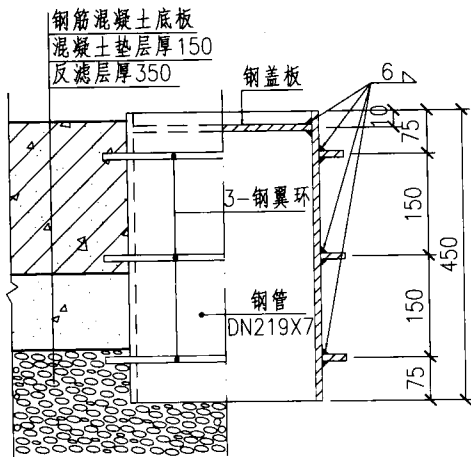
~4号钢筋混凝土沉井化粪池	图集号	11BS4
